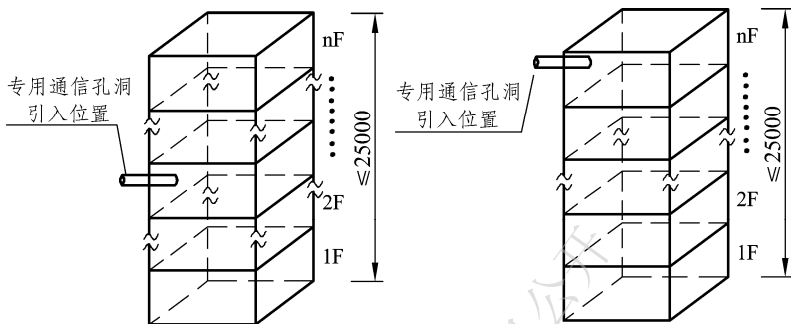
电梯井道设置通信孔洞位置示意图 (单位: mm)
